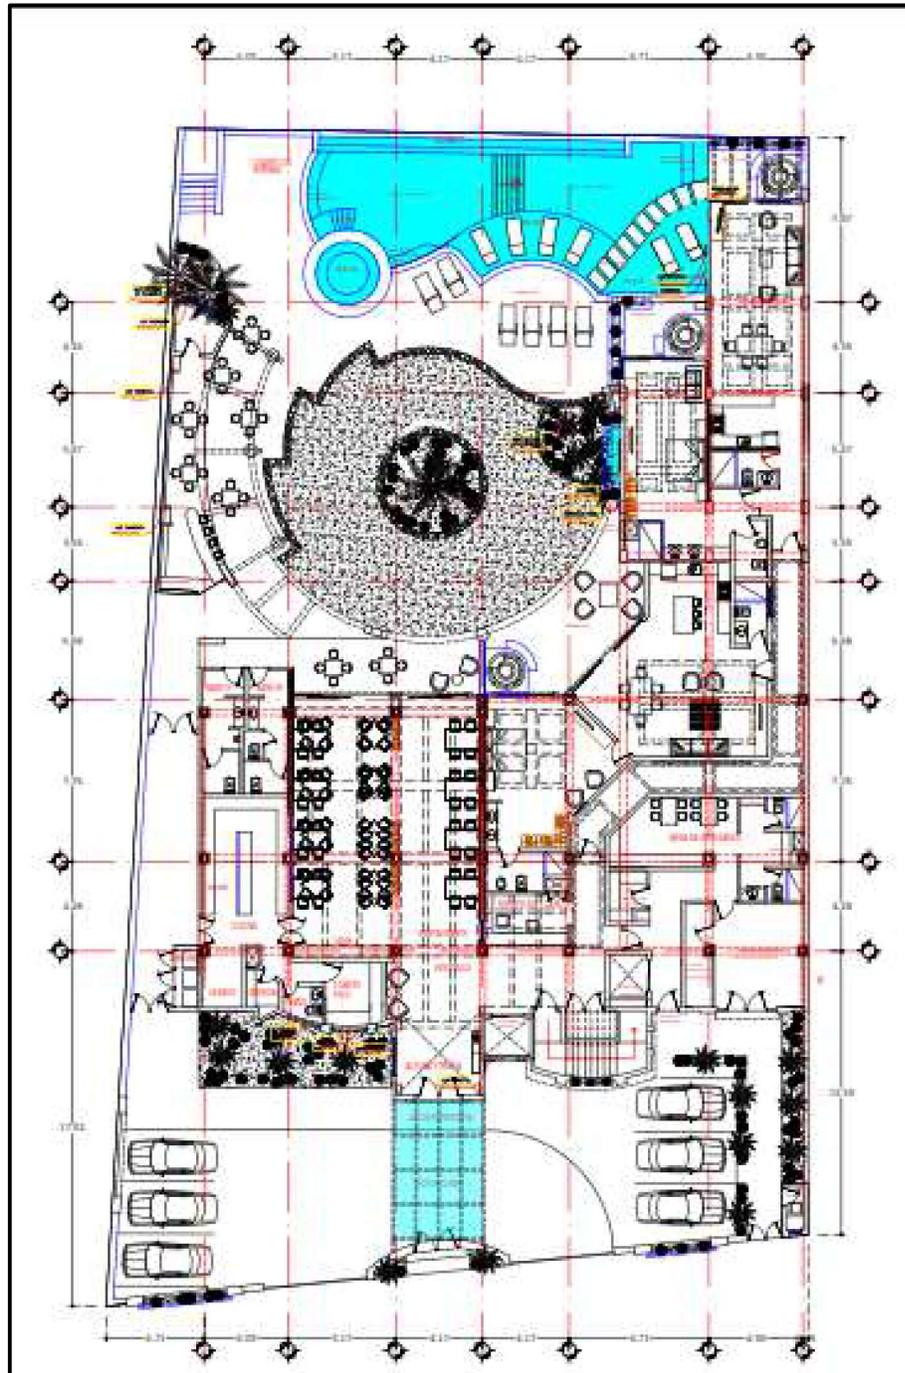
Diseño arquitectónico de planta de conjunto.
